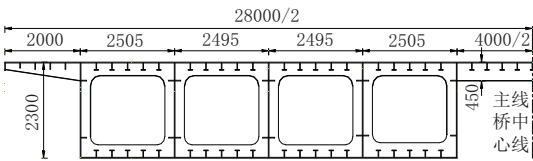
28m 桥宽钢箱梁 1/2 横断面图(单位:mm)
